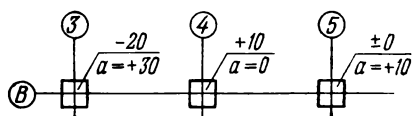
Схема исполнительной съемки фундаментов под железобетонные колонны
